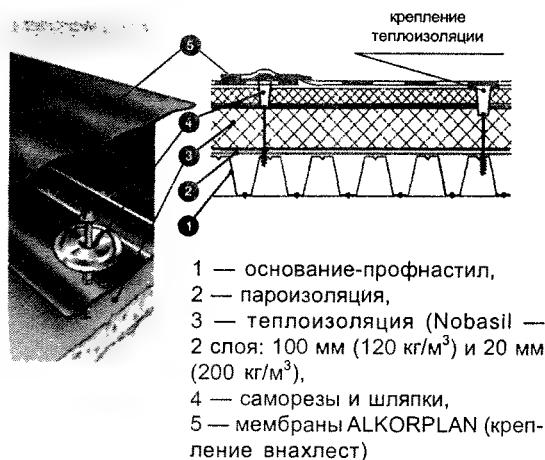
Крепление мембраны ALKORPLAN механическим способом
